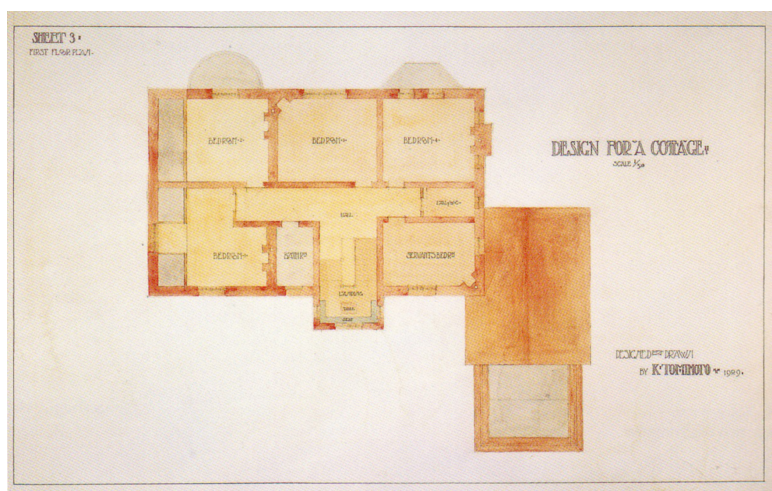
《音楽家住宅設計図案》の2階平面図(SHEET 3)(東京藝術大学所蔵)。
